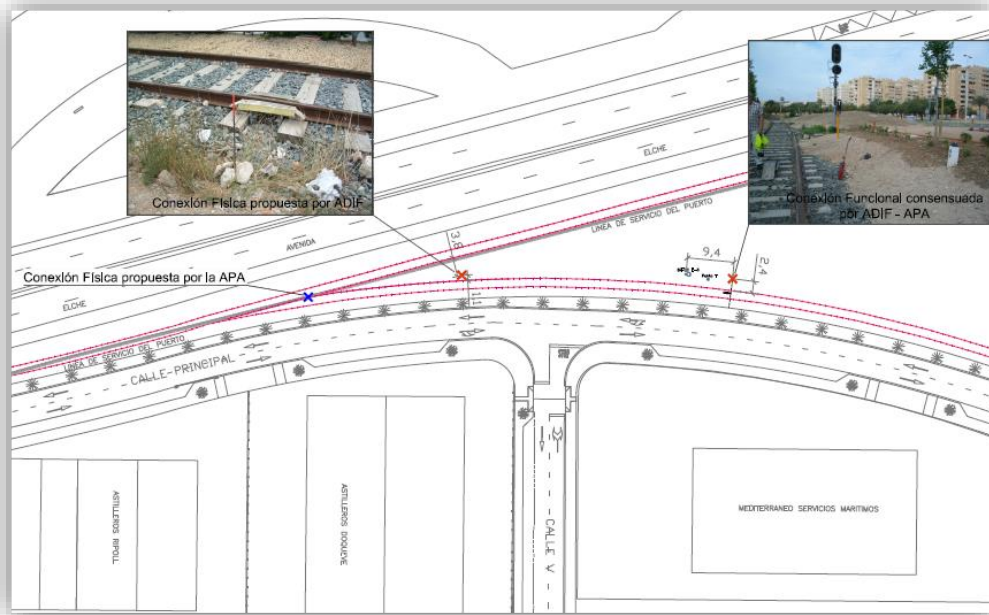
Plano situación Punto E3. Fuente: Planos Cartografía APA.
